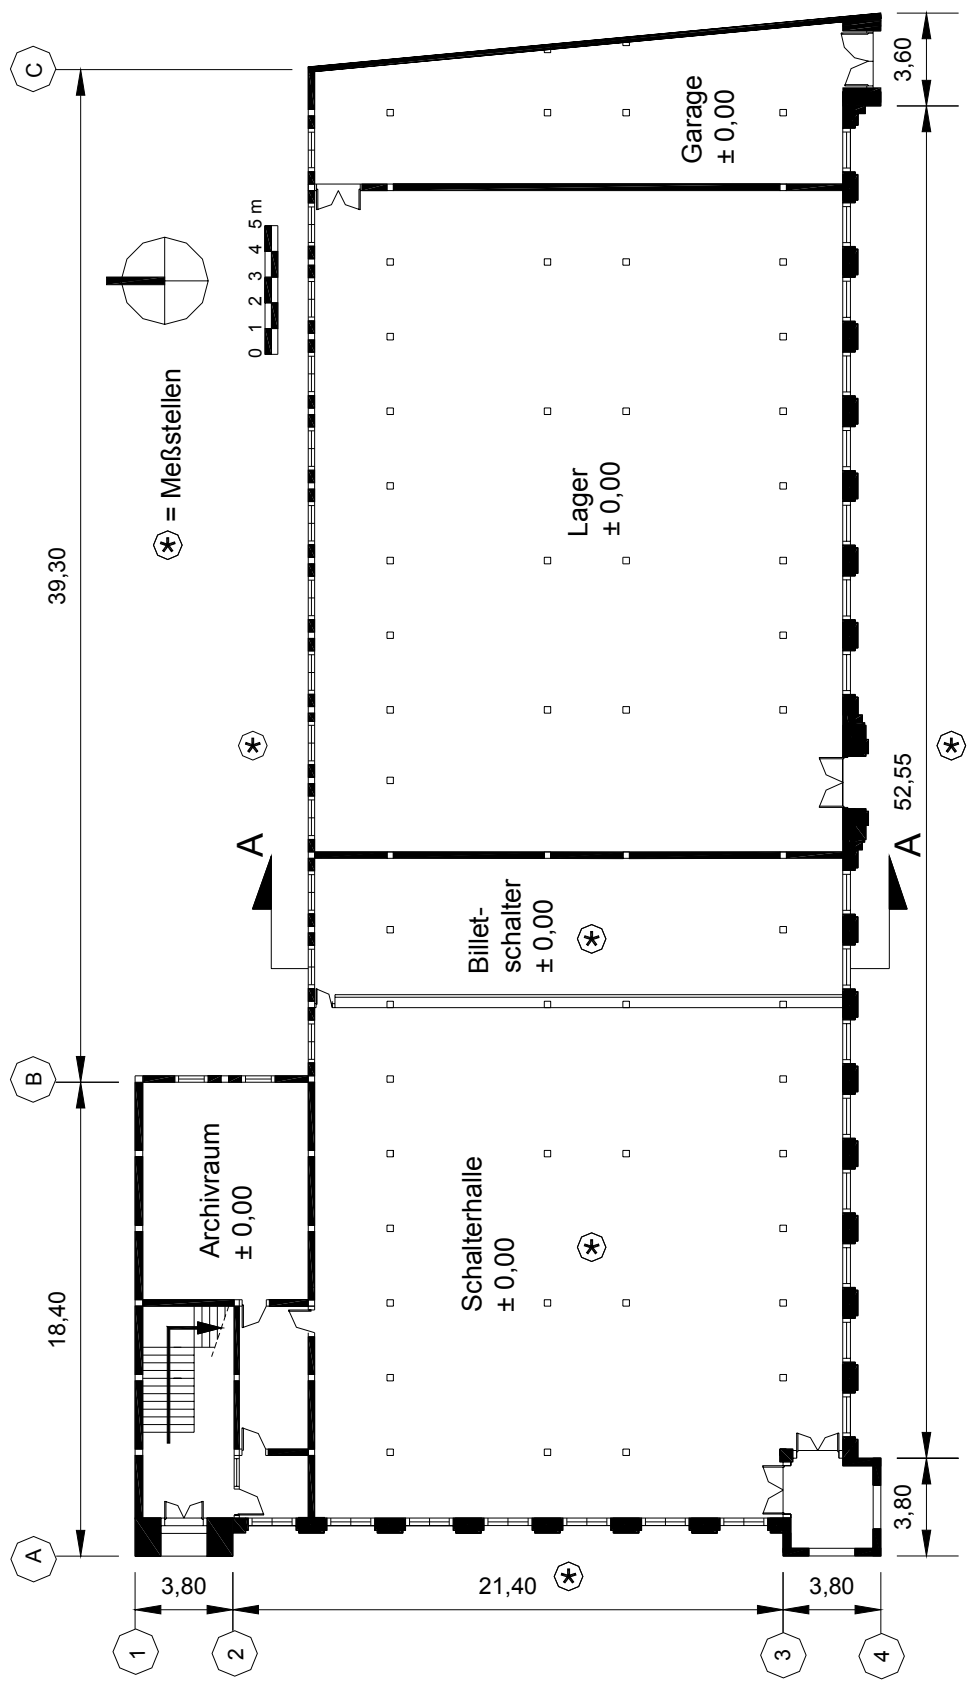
Grundriss Erdgeschoss von Gebäude B4
